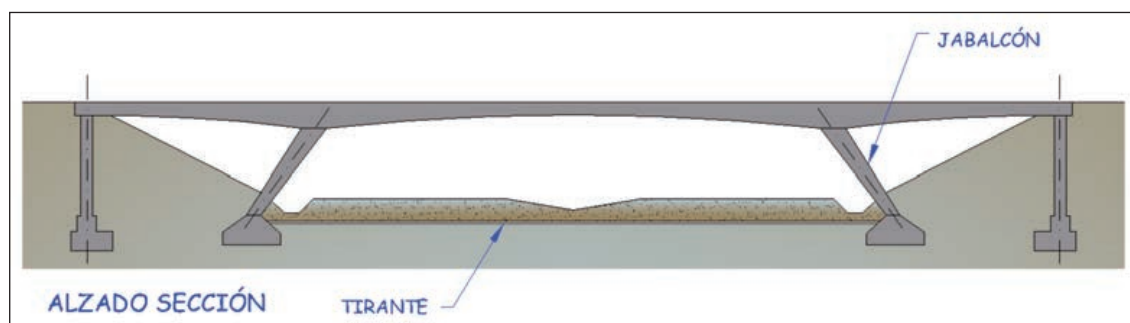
PUENTE PÓRTICO CON PILAS CONECTADAS MEDIANTE TIRANTE ENTERRADO.
